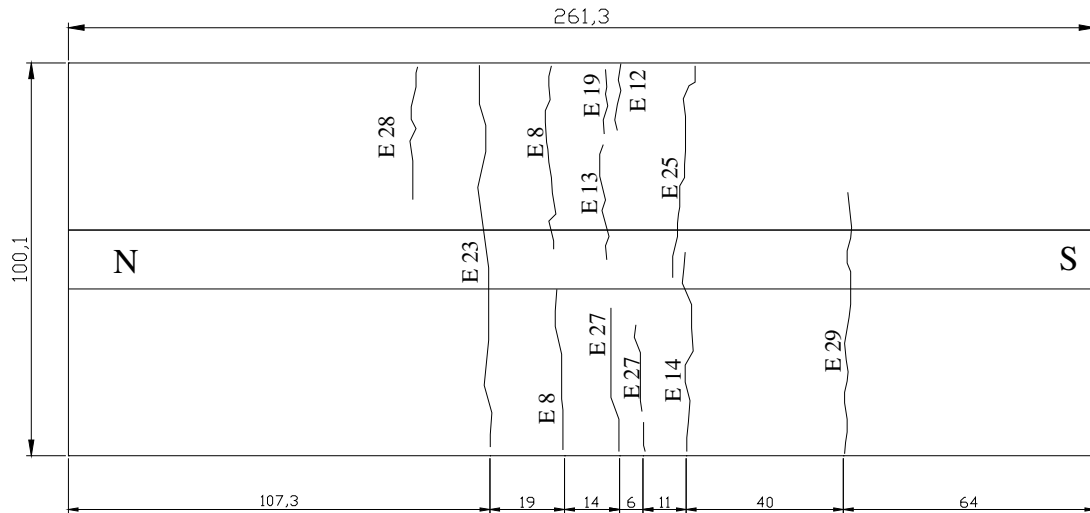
Fissuras do Modelo 2BE (Face inferior da laje) – medidas em cm.
